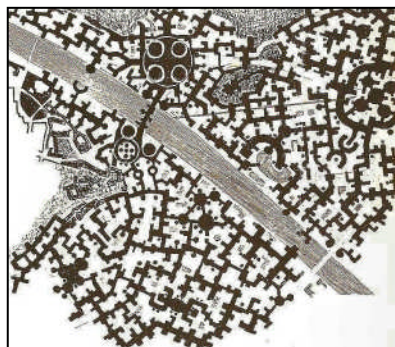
, Gunther Feuerstein, *Megaestrutura de Salzburgo: planta de implantação*, 1966. Caneta e tinta.
